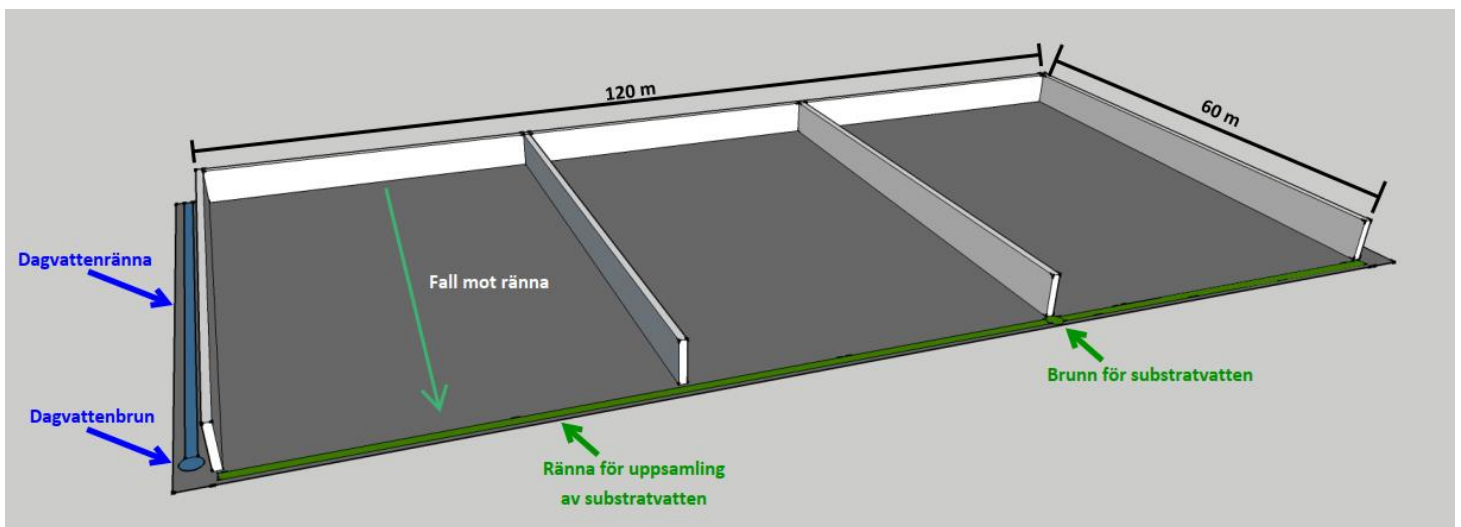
Bild från en 3D-visualisering av Mönsterås-anläggningens planerade utformning där ytan för den planerade plansilon är markerad till vänster i bild. Bilden har kopierats från bolagets bygglovshandlingar.
